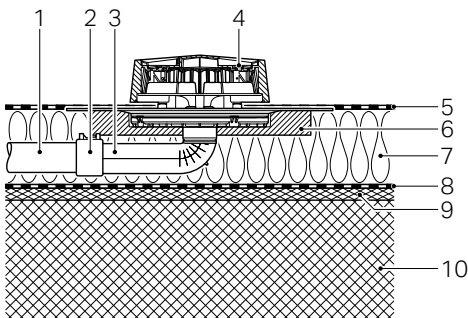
Aufbau Massivdach gedämmt, horizontaler Abgang in Wärmedämmung, mit Dachabdichtungsfolie und Dampfsperre
